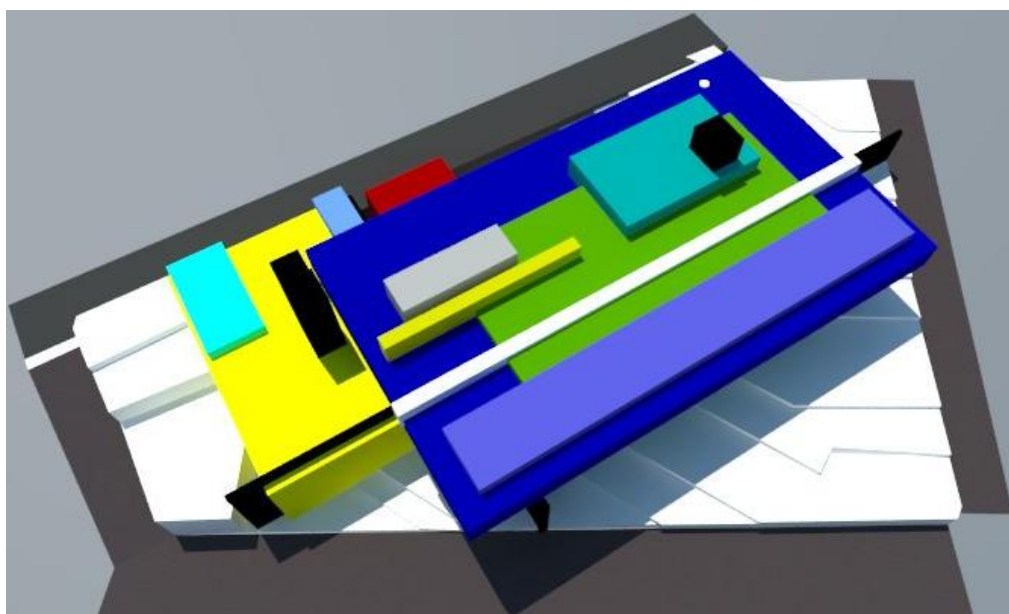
Plan masa plantas altas, zona administrativa, zona de entrenamiento, y seguridad,
